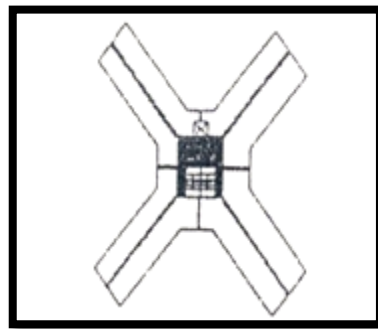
Bentuk Denah *Expanded Tower Plan
